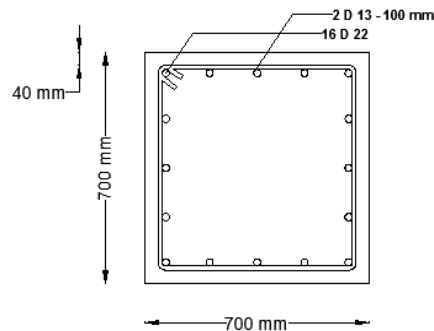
Detail Penulangan Balok Kantilever Bangunan 1a dan 1b
